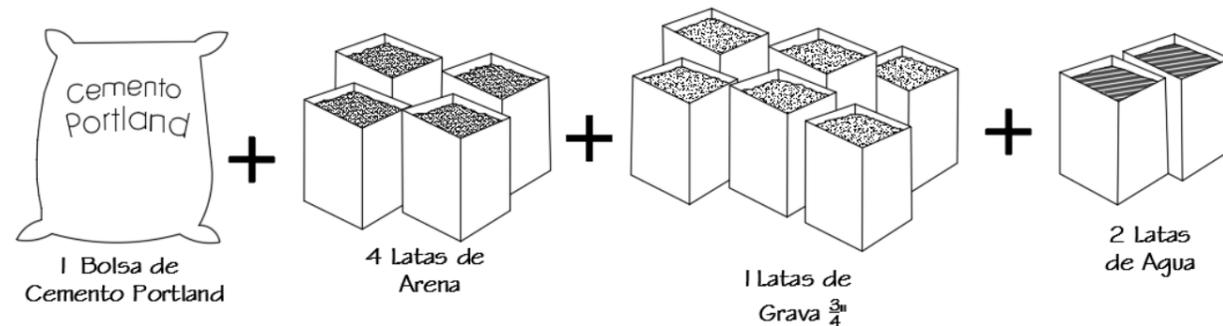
Dosificación Para Cimientos Columnas y Vigas.
